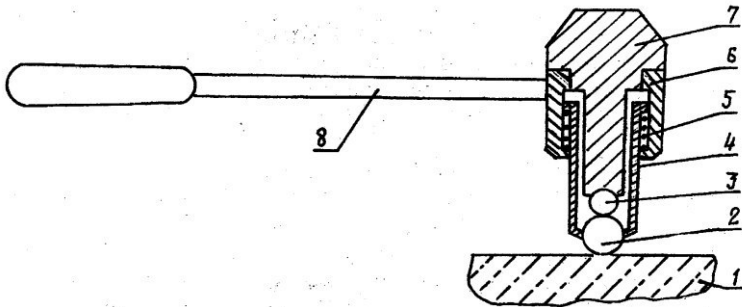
Еталонний молоток Кашкарова: 1 – бетон, що випробовується; 2 – кулька; 3 – еталонний стержень; 4 – стакан; 5 – пружина; 6 – корпус; 7 – оголовок; 8 - ручка
